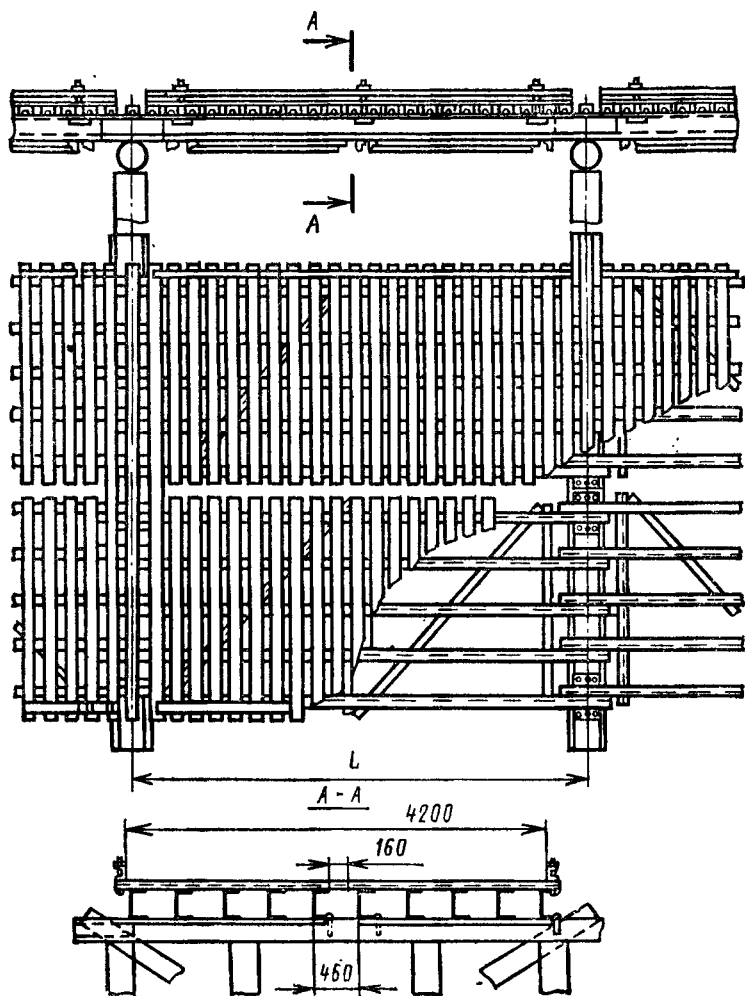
Пролетное строение из цельнометаллических колеиных блоков
